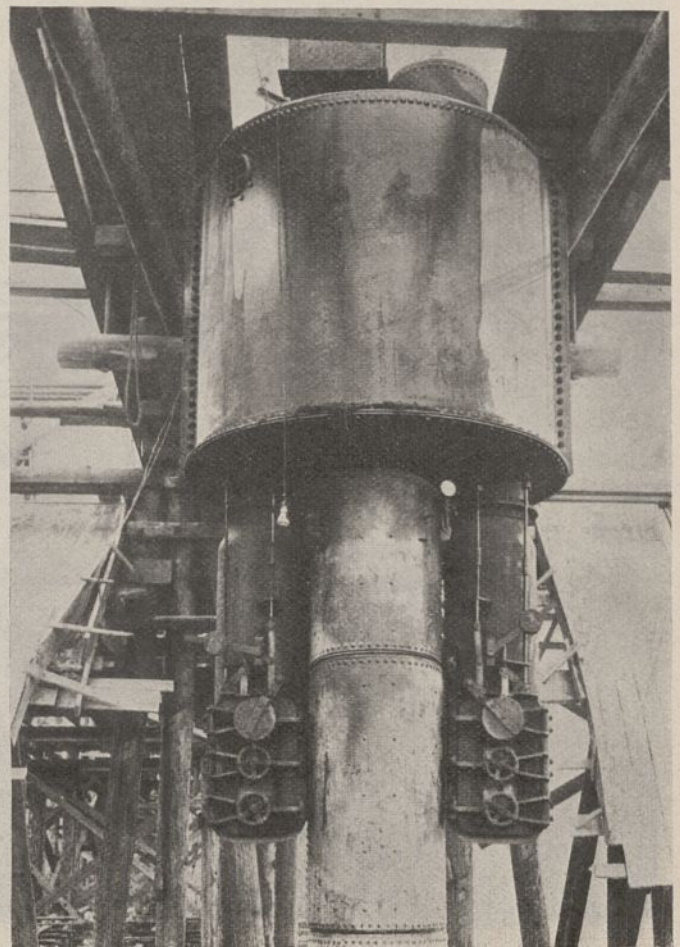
Schleuse mit Hosen für die Bodenförderung.
